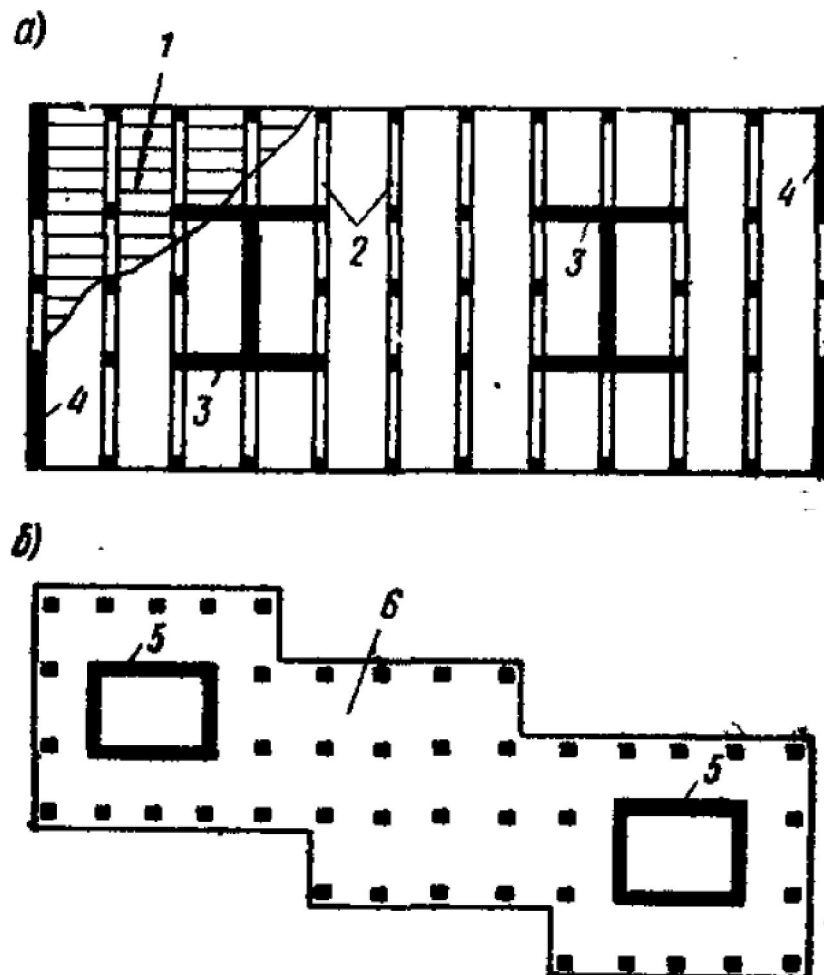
Конструктивные планы многоэтажных каркасных зданий (а- с двумя ядрами жесткости; б- с двумя ядрами жесткости, сложной конфигурации, возводимые методом подъема перекрытий; 1 - плиты перекрытия; 2 - ригели рам; 3 - ядро жесткости двутаврового профиля; 4 - связевые диафрагмы; 5 - замкнутое ядро жесткости; 6- монолитное безбалочное перекрытие). [1]
